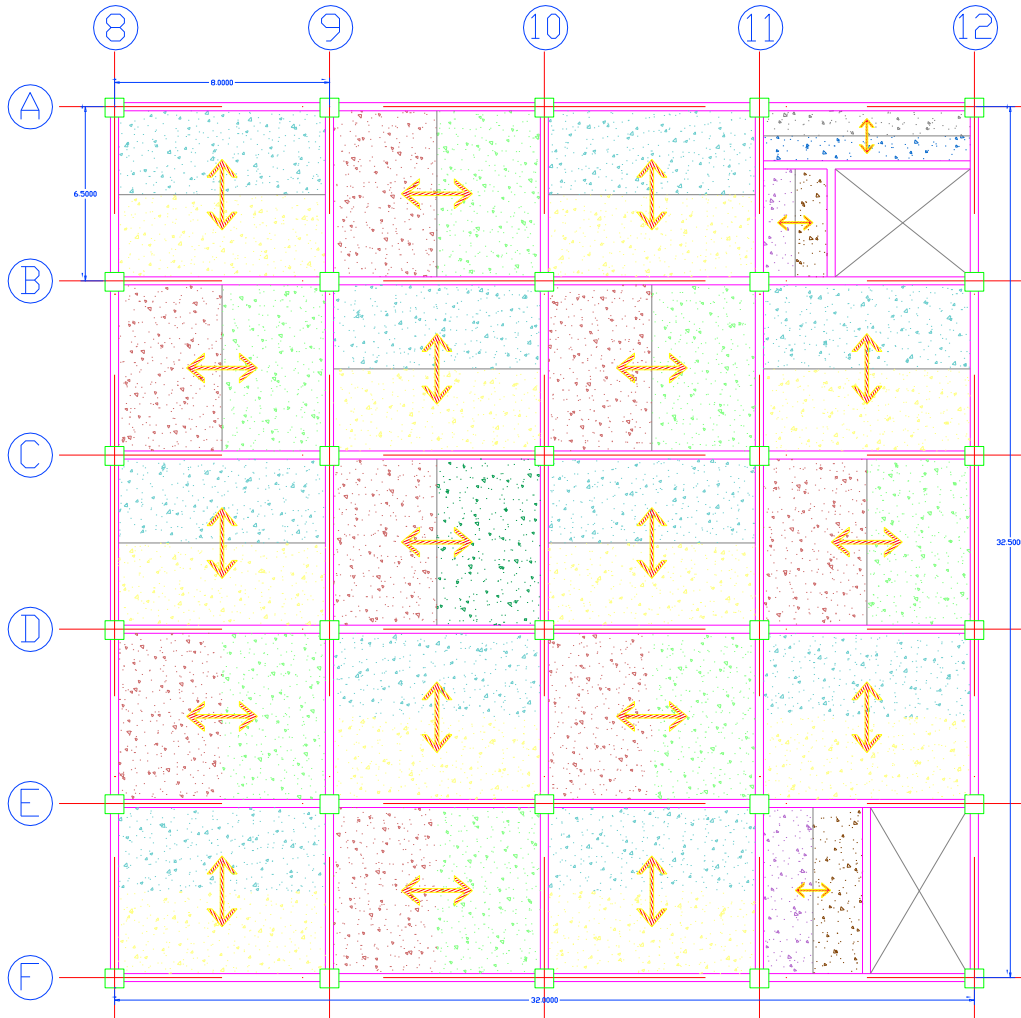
Distribución de las losas de entrespiso para la planta baja y niveles del 2 al 6
